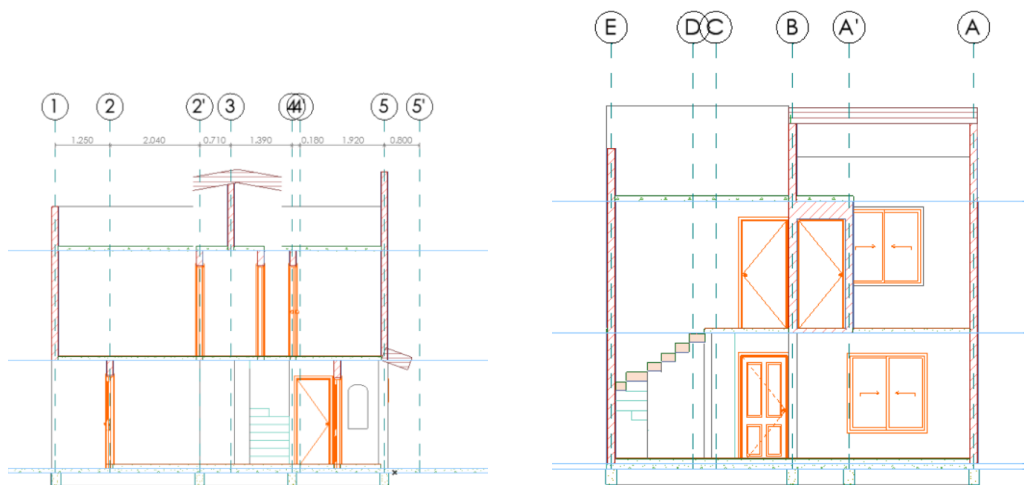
Corte 1 Longitudinal y corte 2 transversal
